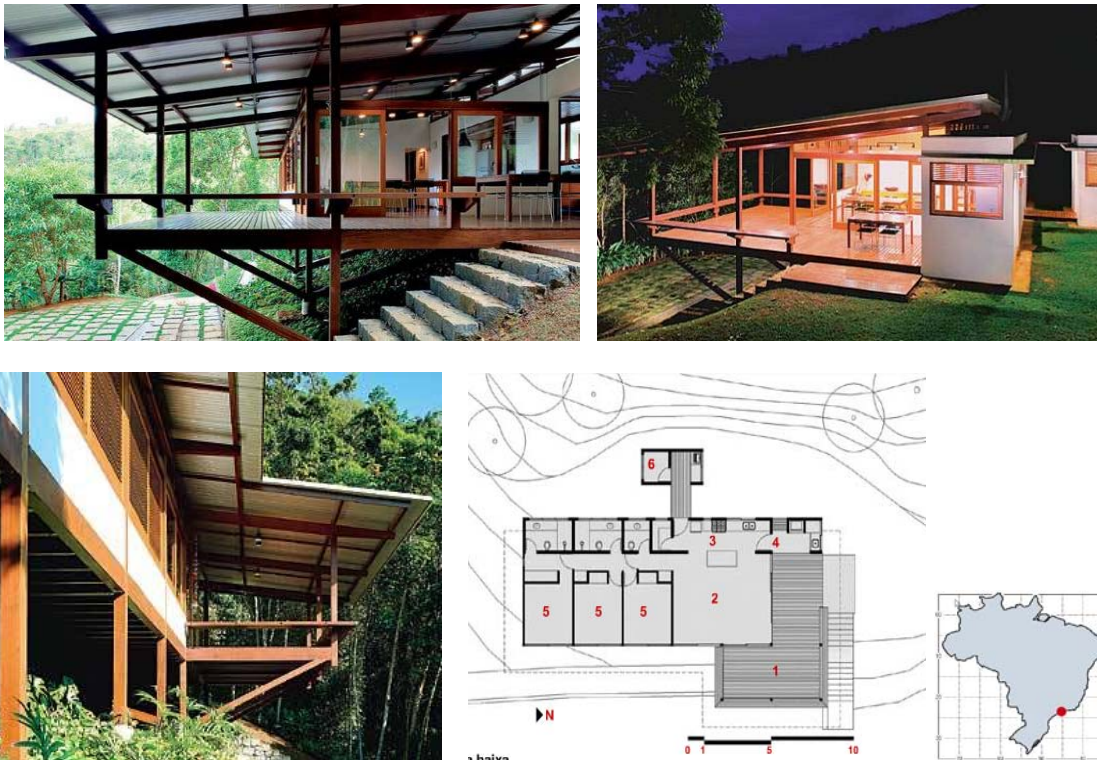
Casa Brava II. Renato e Lilian dal Pian, Ubatuba, 2007. Fuente: PROJETO, 2008.
